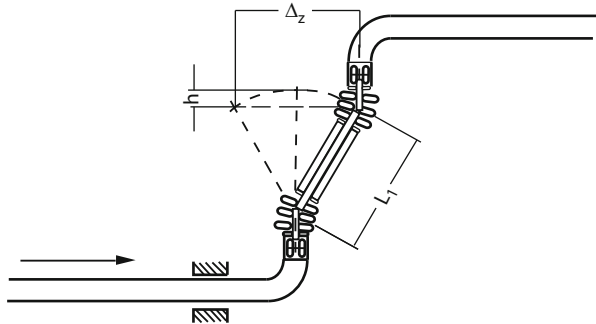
Gelenkkompensatoren mit Anschweißende oder festem Flansch
